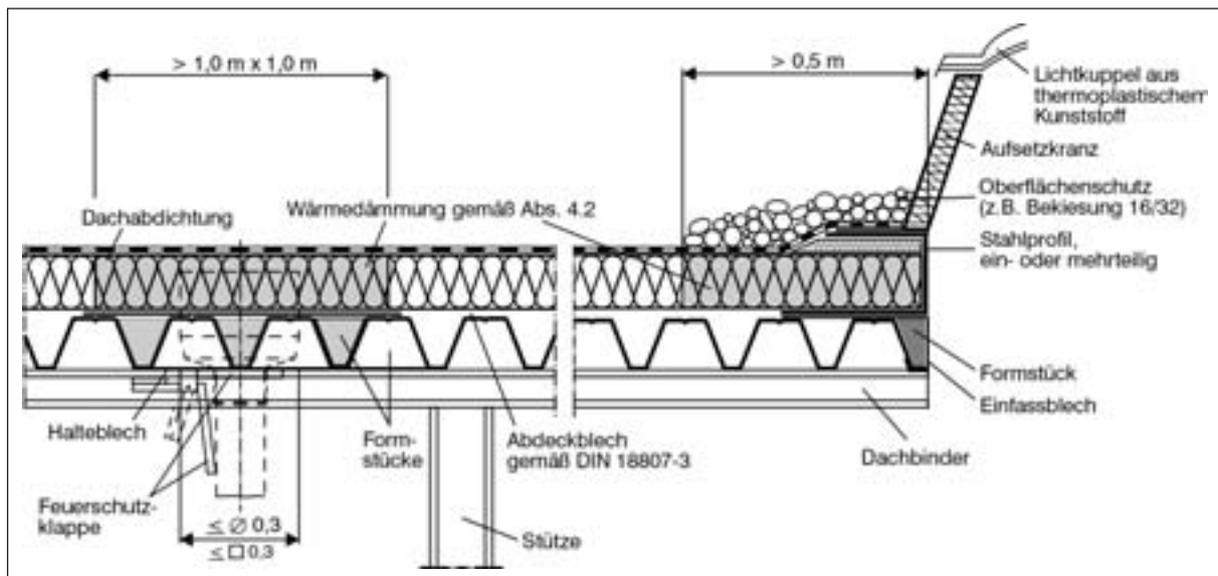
Konstruktives Beispiel einer Dachdurchdringung
